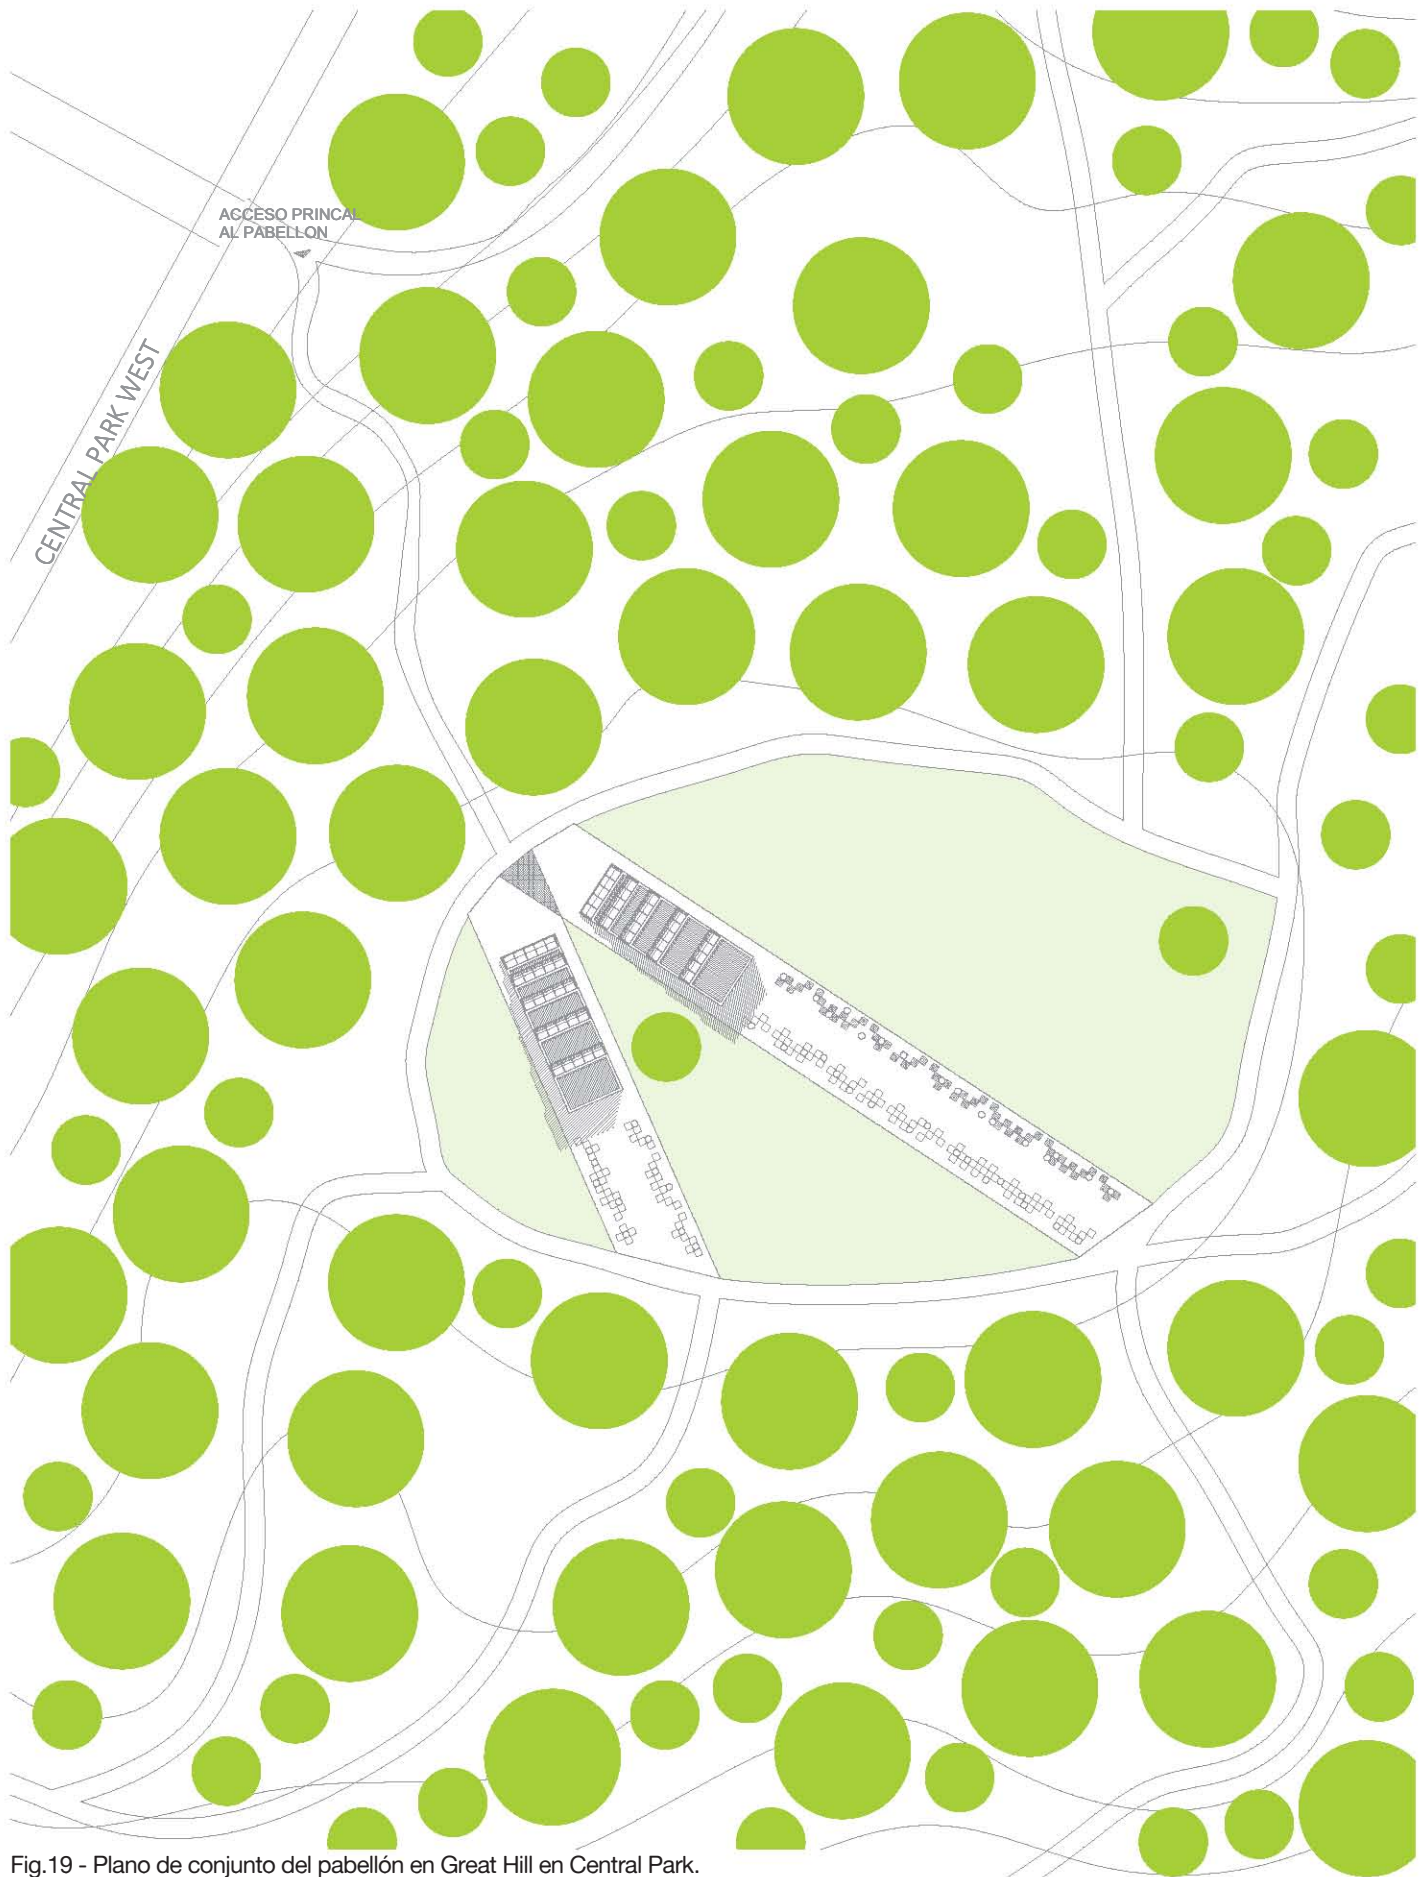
Plano de conjunto del pabellón en Great Hill en Central Park.
